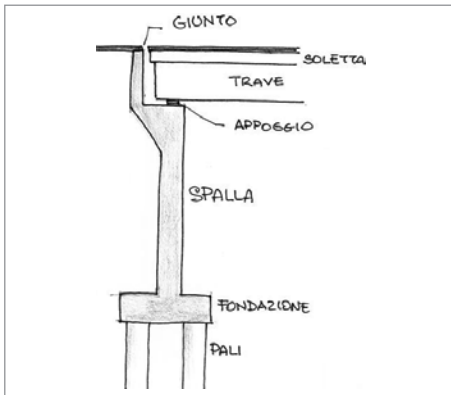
Sezione spalla con nomenclatura
